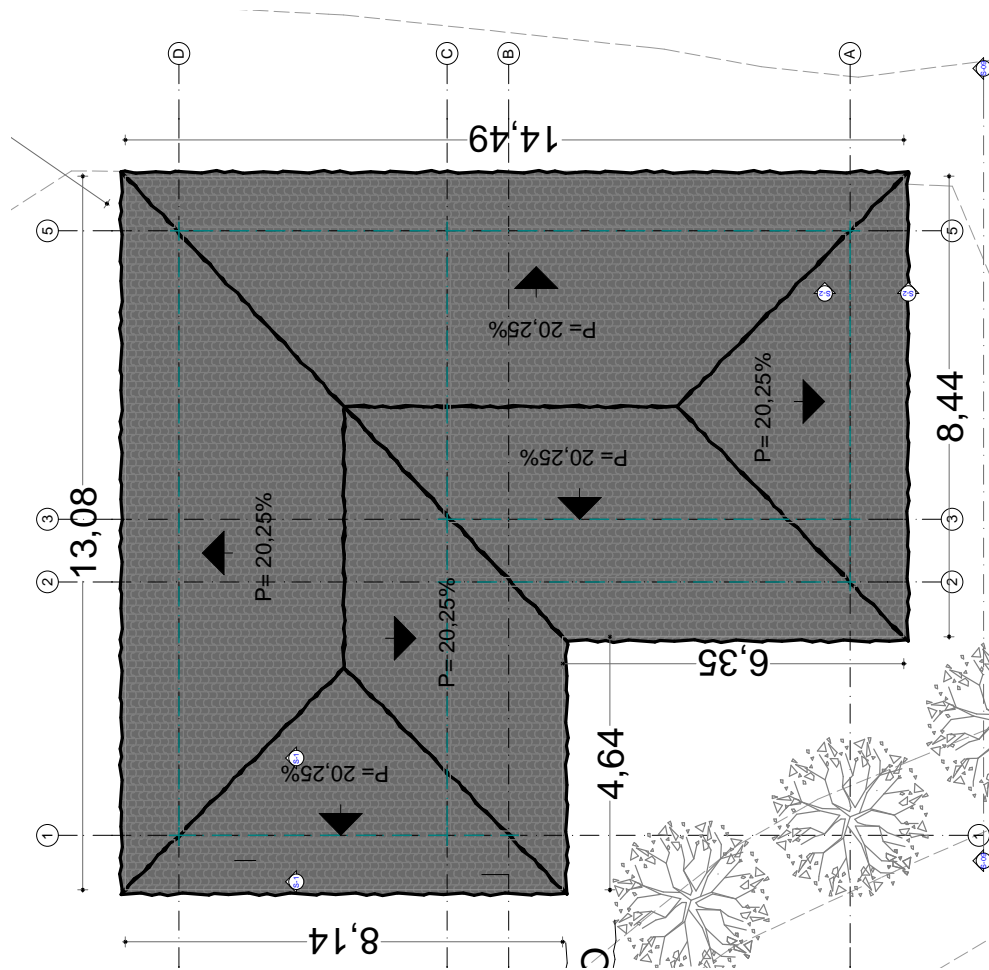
Planta de cubierta. Casa de Manuel Guamán. Fuente: Investigador
